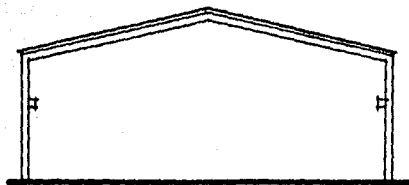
ESTRUCTURA A BASE DE MARCO RIGIDO DE SECCION CONSTANTE
